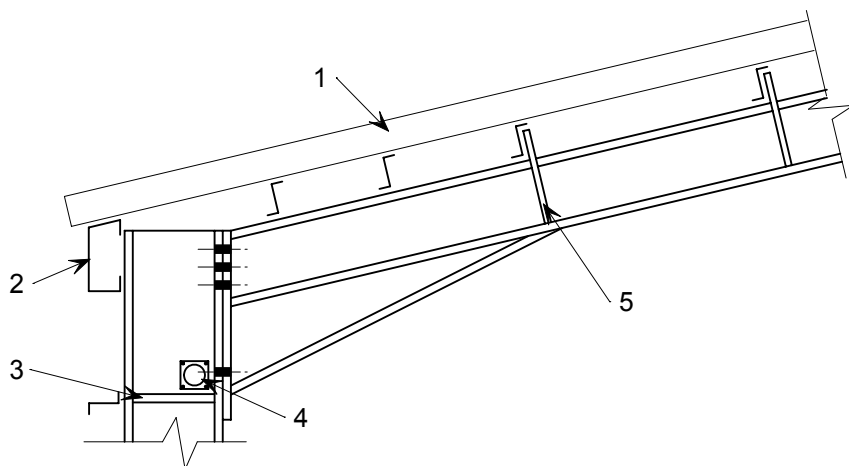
Detail vyztužení proti zkroucení uzavřeným kruhovým profilem s podélným vyztužením
